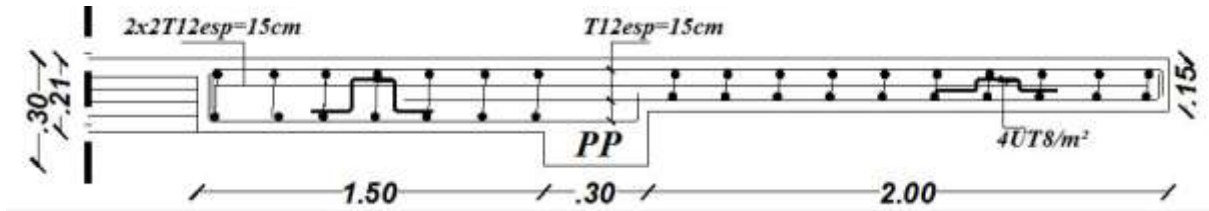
Ferrailage de dalle pleine eps=15 cm
